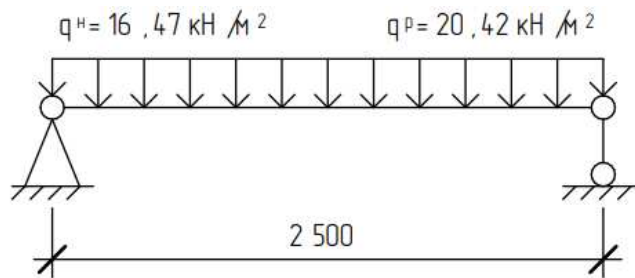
Расчетная схема условной балки настила: q^H – нормативная нагрузка, q^P – расчетная нагрузка.
